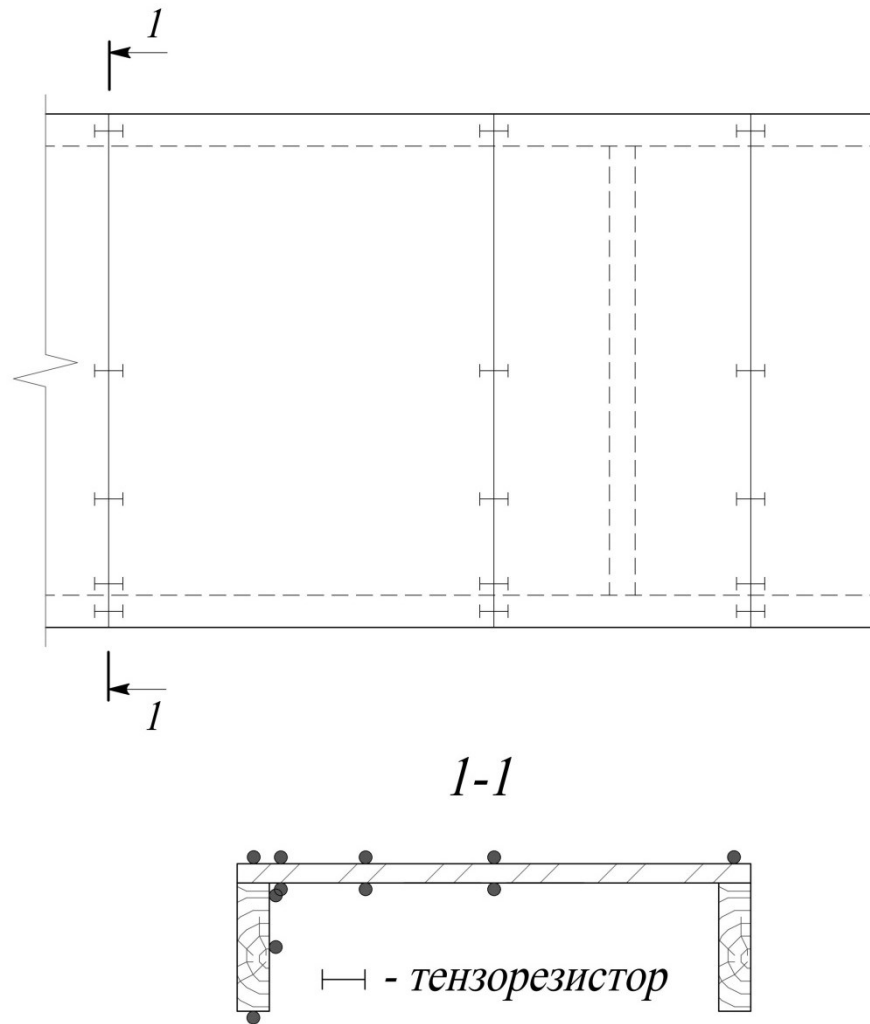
Схема размещения тензорезисторов на панельной конструкции
